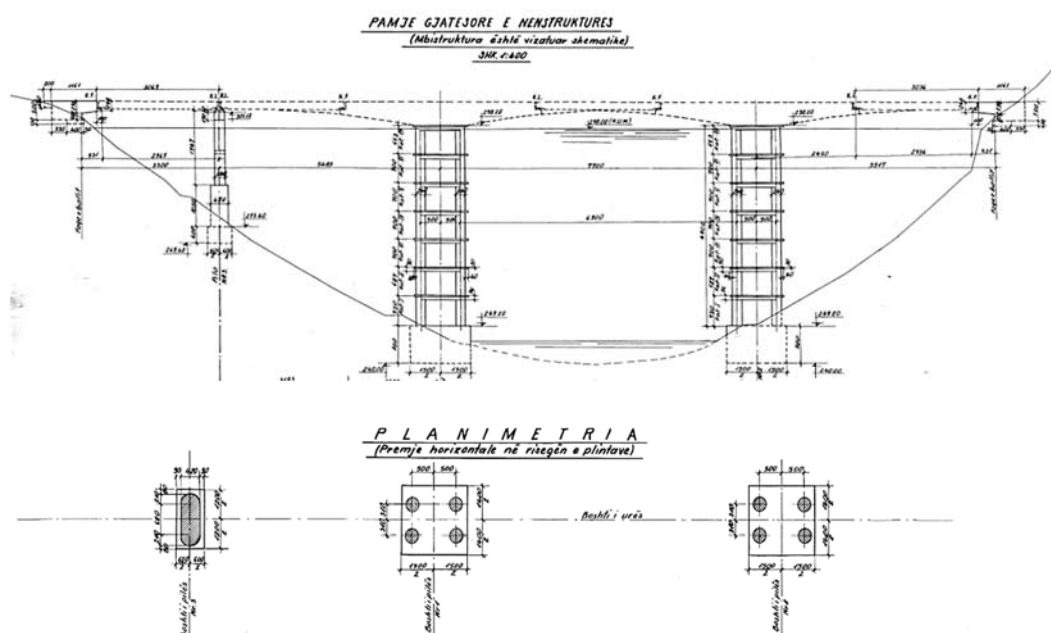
Planimetria. Prerje horizontale në risegën e plintave ([6])
